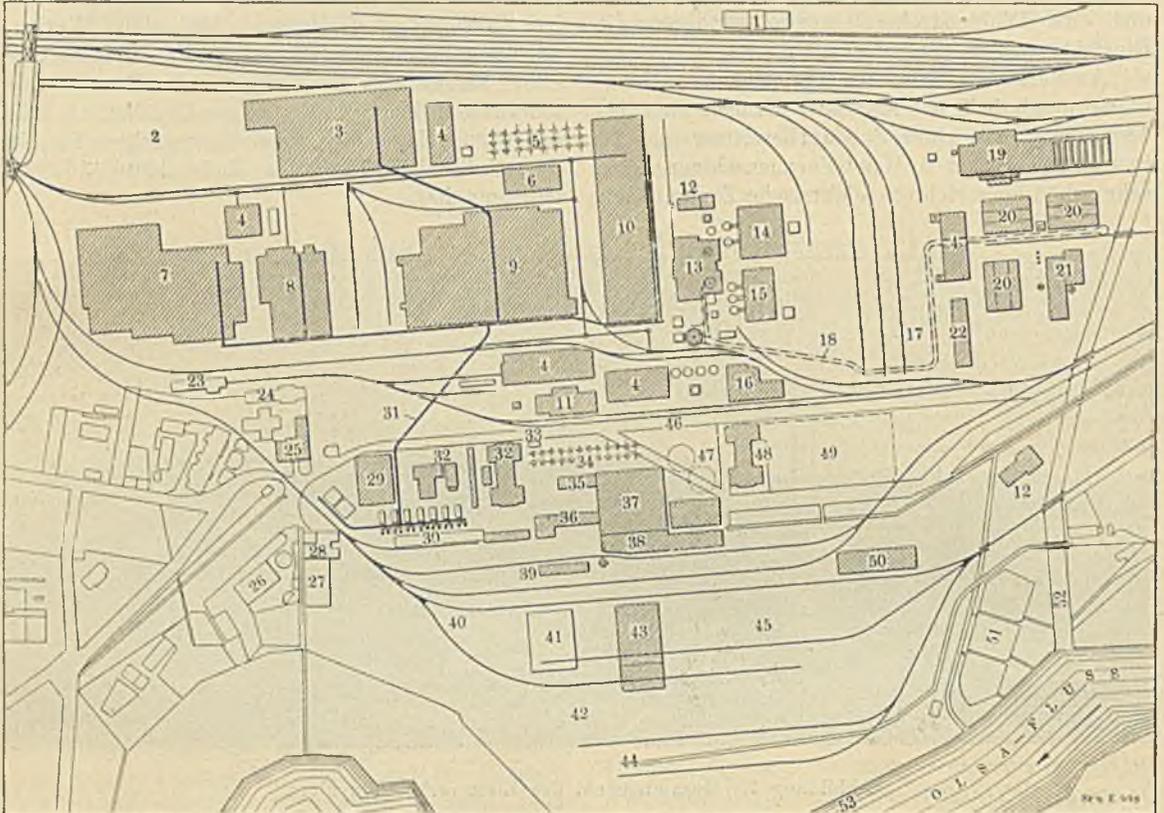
Lageplan des Eisenwerkes Trzynitz.
